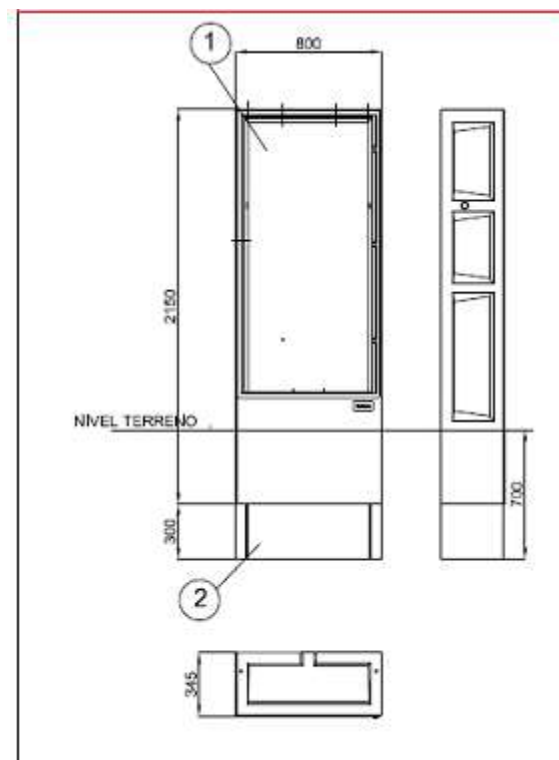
Detall armari prefabricat instal·lació d'enllaç
